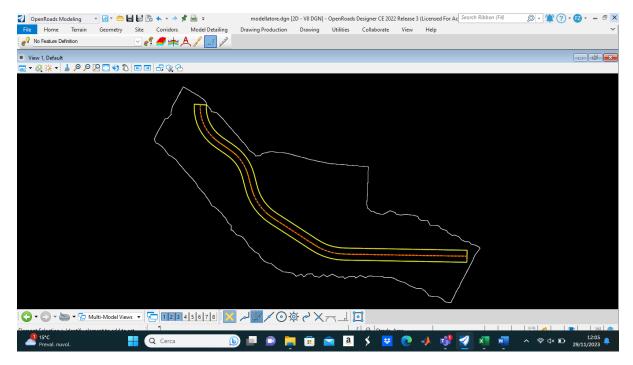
Sopraelevazione del tracciato vista in pianta
